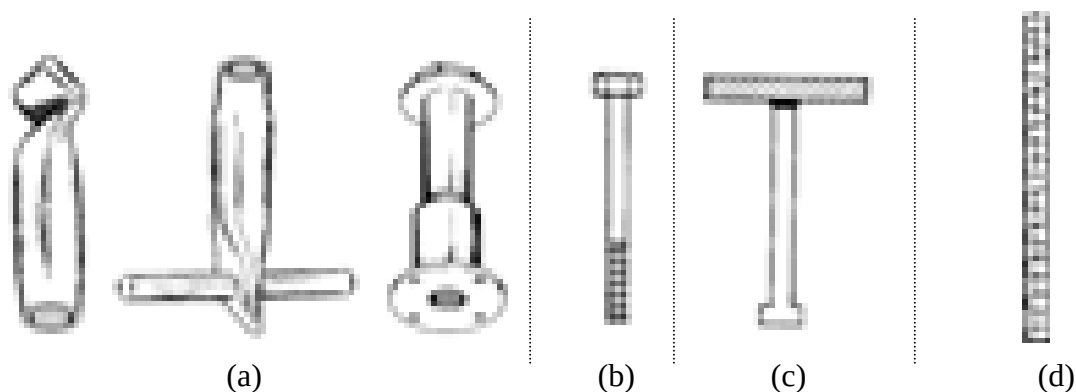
Tipos de ancoragem pré-instalada. (a) Encaixes com rosca; (b) Parafuso com cabeça; (c) Pino com cabeça; (d) Barra retas nervurada; (Adaptado de Fastenings to Concrete and Masonry Structures – CEB, 1994).
